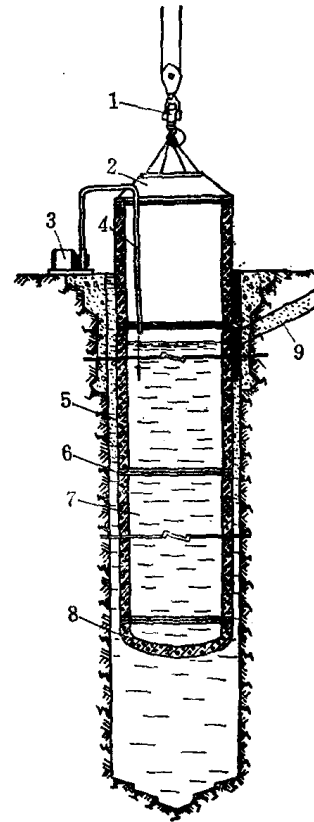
钢筋混凝土井壁悬浮下沉示意图
